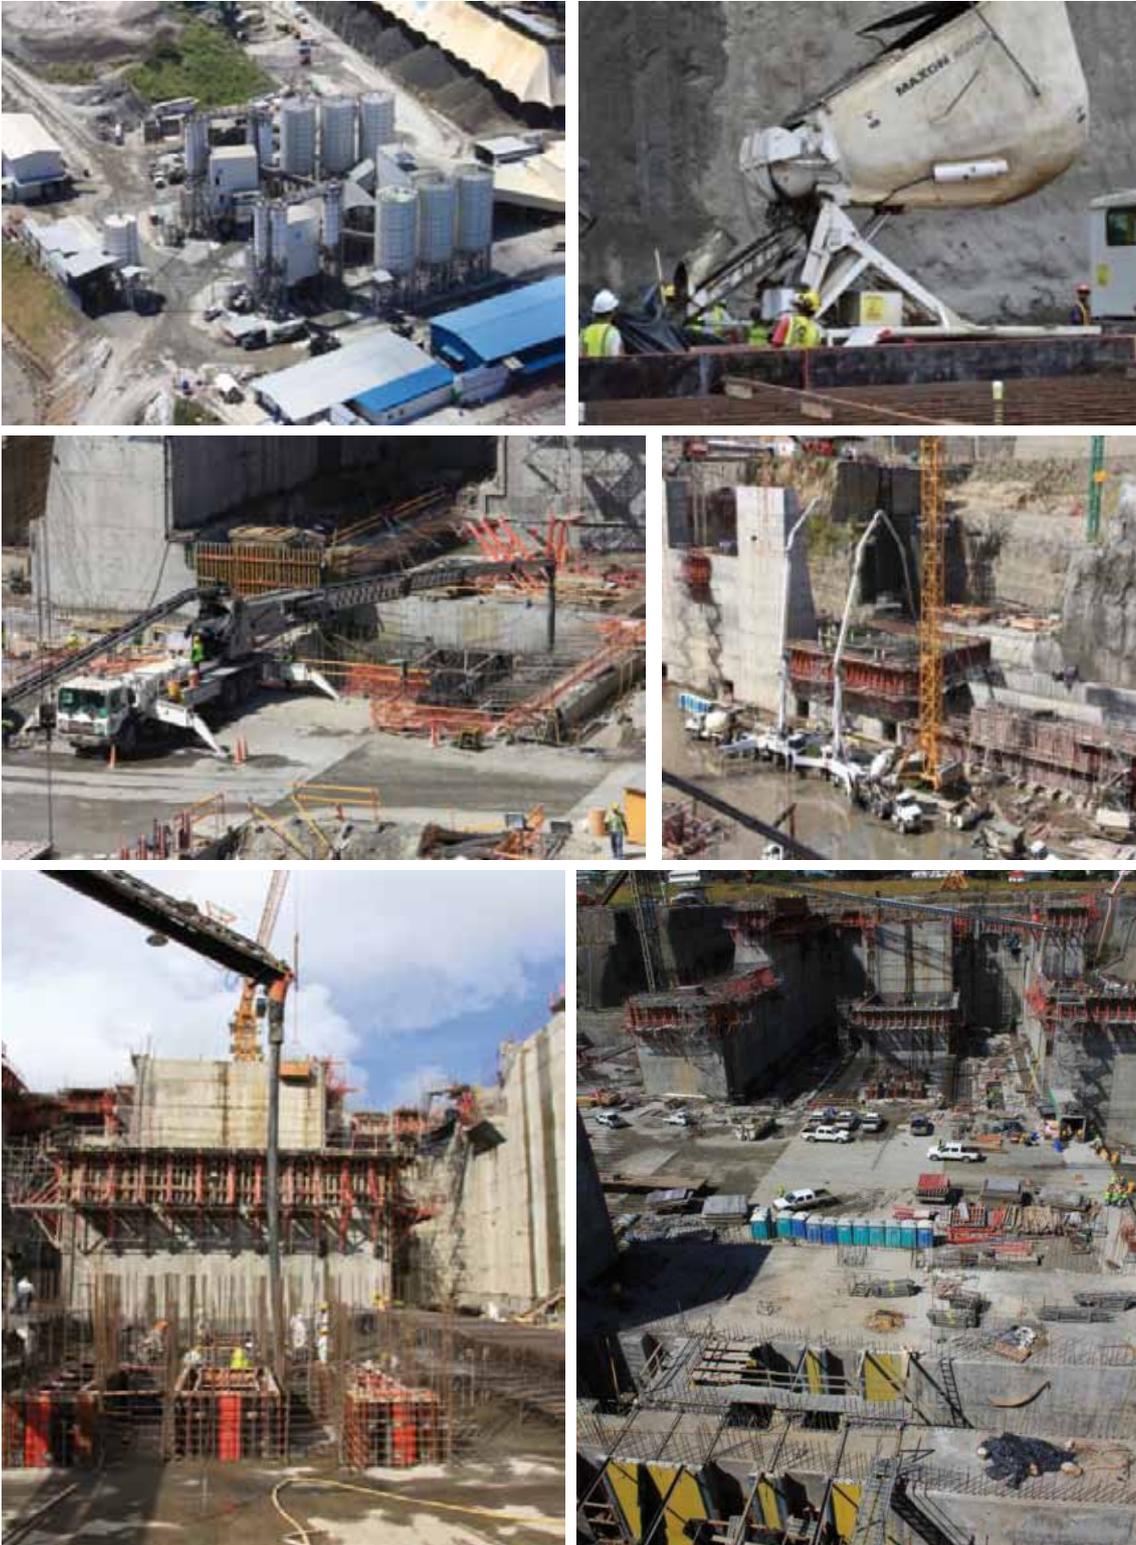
Planta de hormigón principal, transporte y colocación de hormigón con cinta móvil, bombas y cinta fija sobre grúa torre
